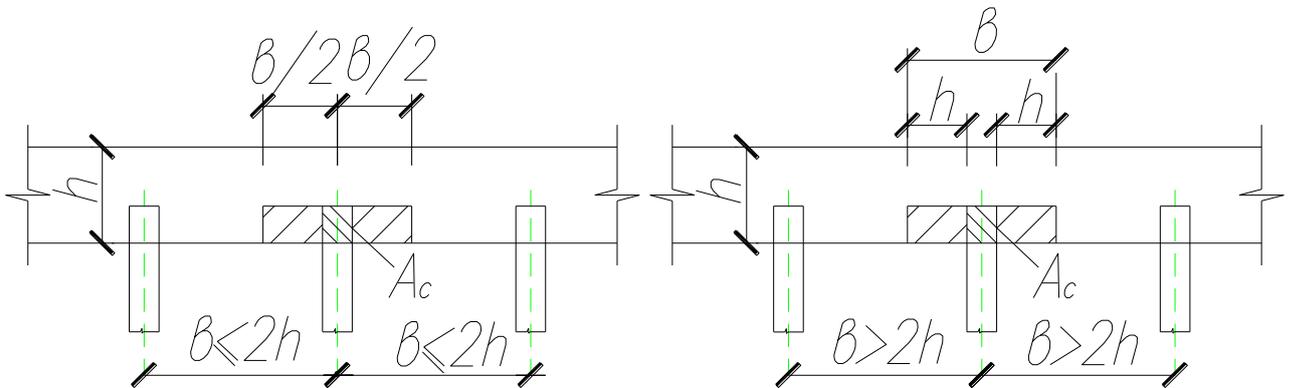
Определение расчетных площадей сечений при местном сжатии
